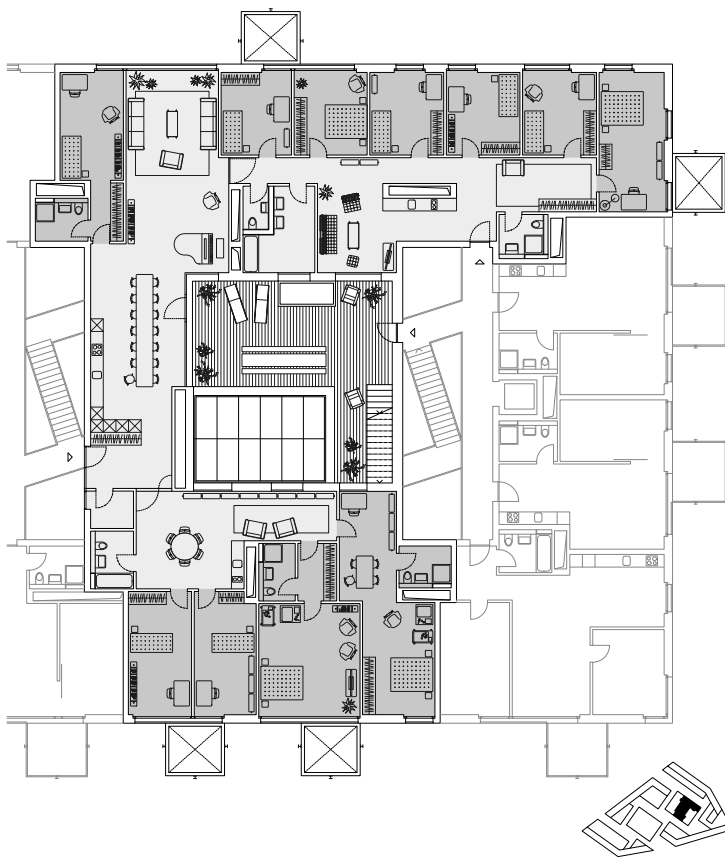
Kraftwerk1 Zwicky Süd, Grundriss 13,5 Zimmer-Wohnung, Schneider Studer Primas Architekten Zürich
